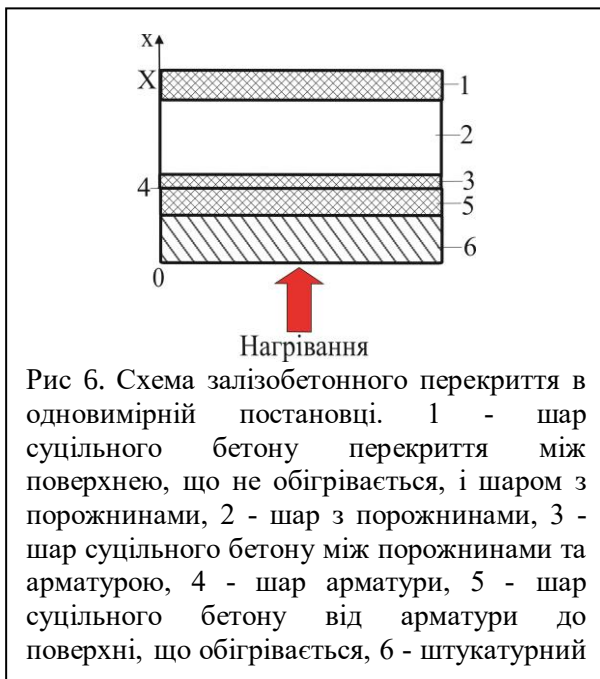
Схема залізобетонного перекриття в одновимірній постановці. 1 - шар суцільного бетону перекриття між поверхнею, що не обігрівається, і шаром з порожнинами, 2 - шар з порожнинами, 3 - шар суцільного бетону між порожнинами та арматурою, 4 - шар арматури, 5 - шар суцільного бетону від арматури до поверхні, що обігрівається, 6 - штукатурний
